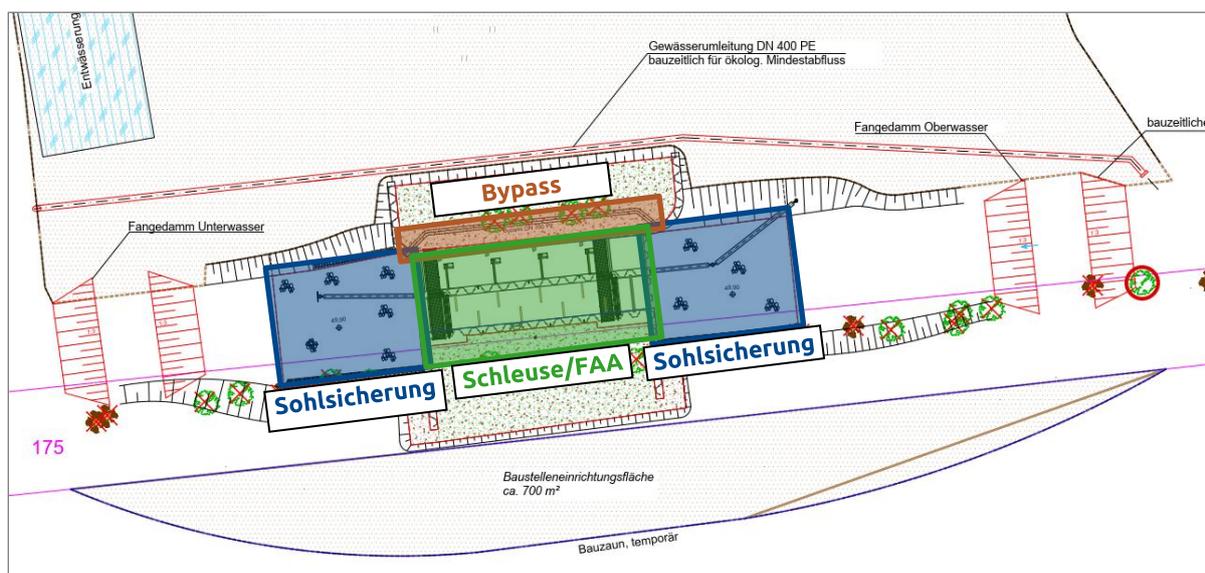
Wehr 42 - Überblick zu benötigten Wasserhaltungen (Lageplan aus /P3/)
